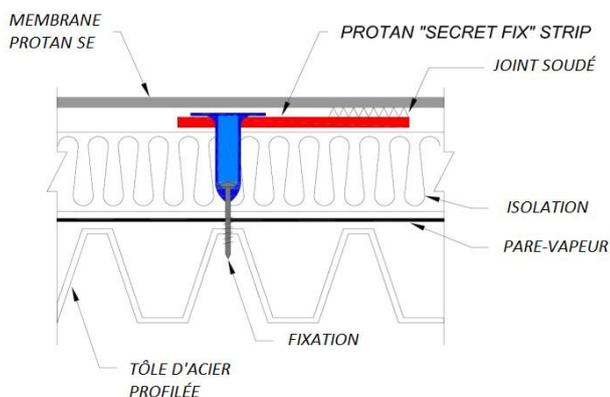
Pose au moyen du système PROTAN SECRET FIX STRIP
